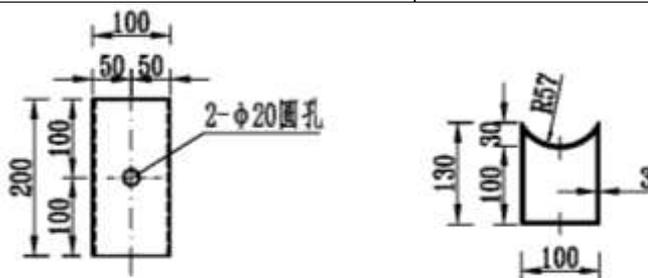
护栏标准断面构造断面图（尺寸单位：mm）
